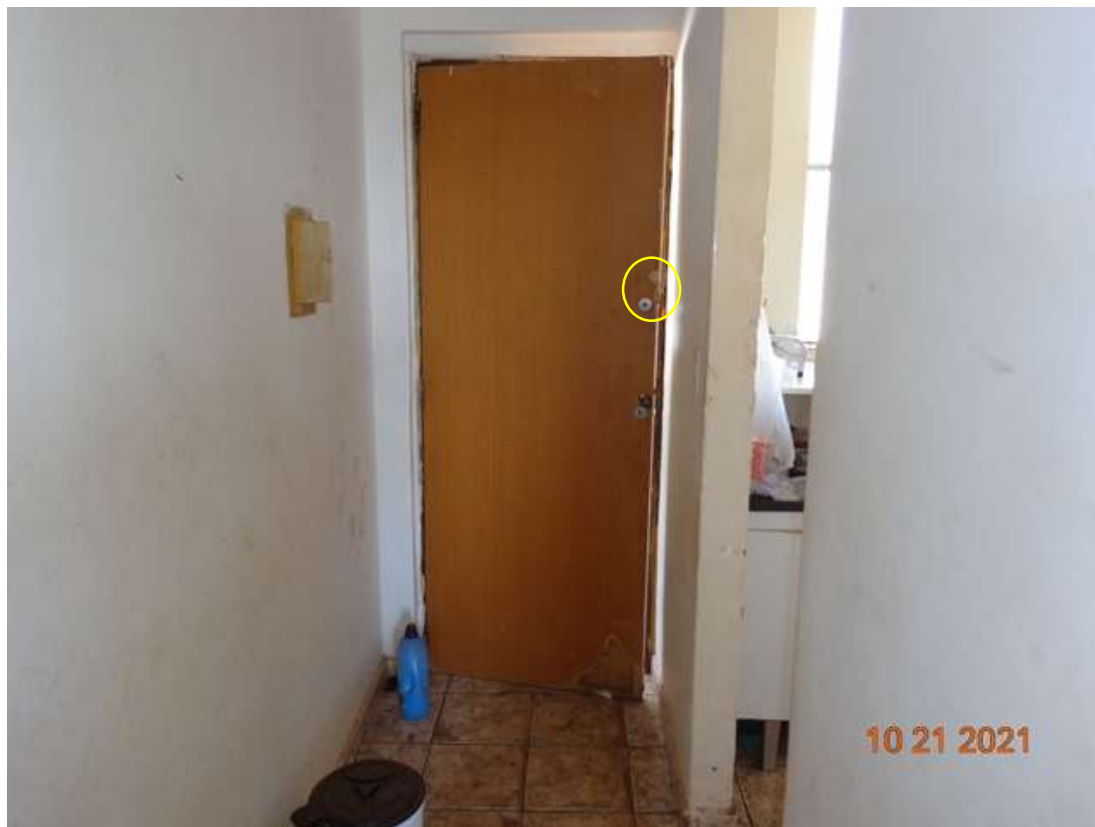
Detalhe da porta de entrada do imóvel pelo lado interno do apartamento.
